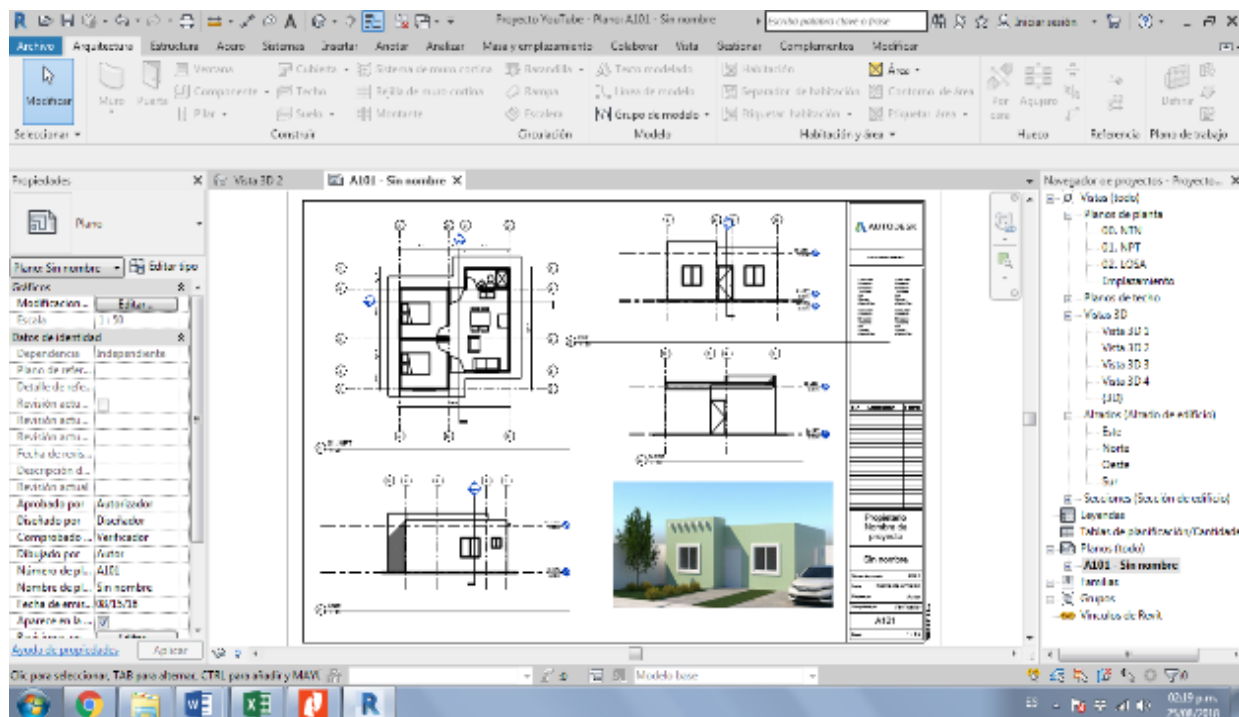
Proyecto arquitectónico piloto de implementación BIM.
